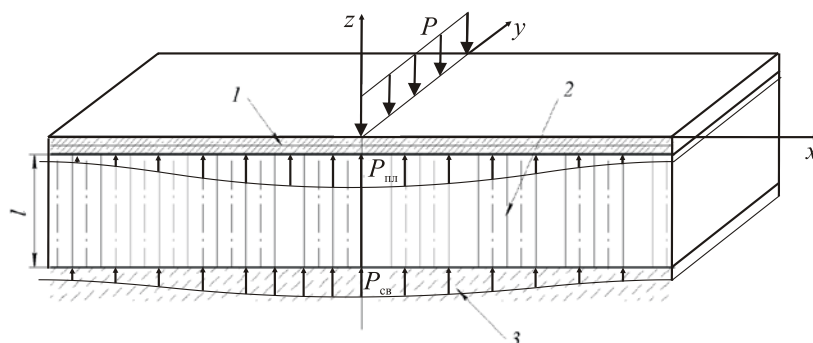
Расчетная схема – две параллельно лежащие плиты на грунтовом основании: железобетонная фундаментная плита 1 и плита 2 с эффективными свойствами, определяемыми взаимодействием свай с грунтом 3.
